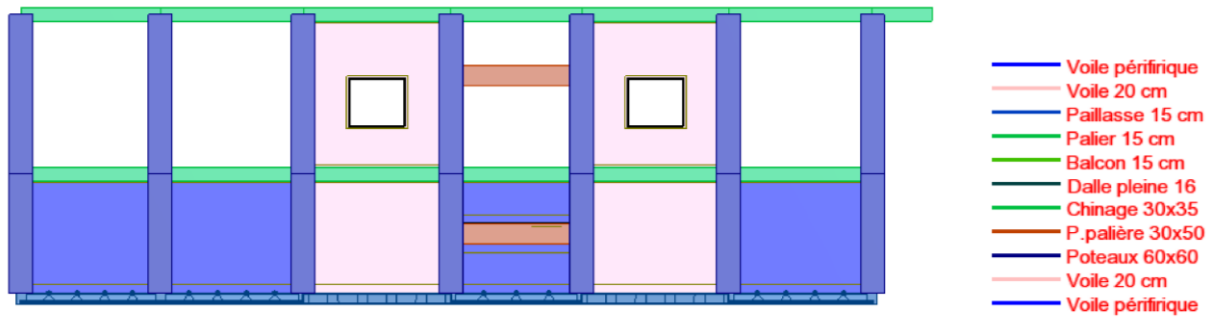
Schéma des voiles périphériques transversales avec les poteaux et les poutres.
